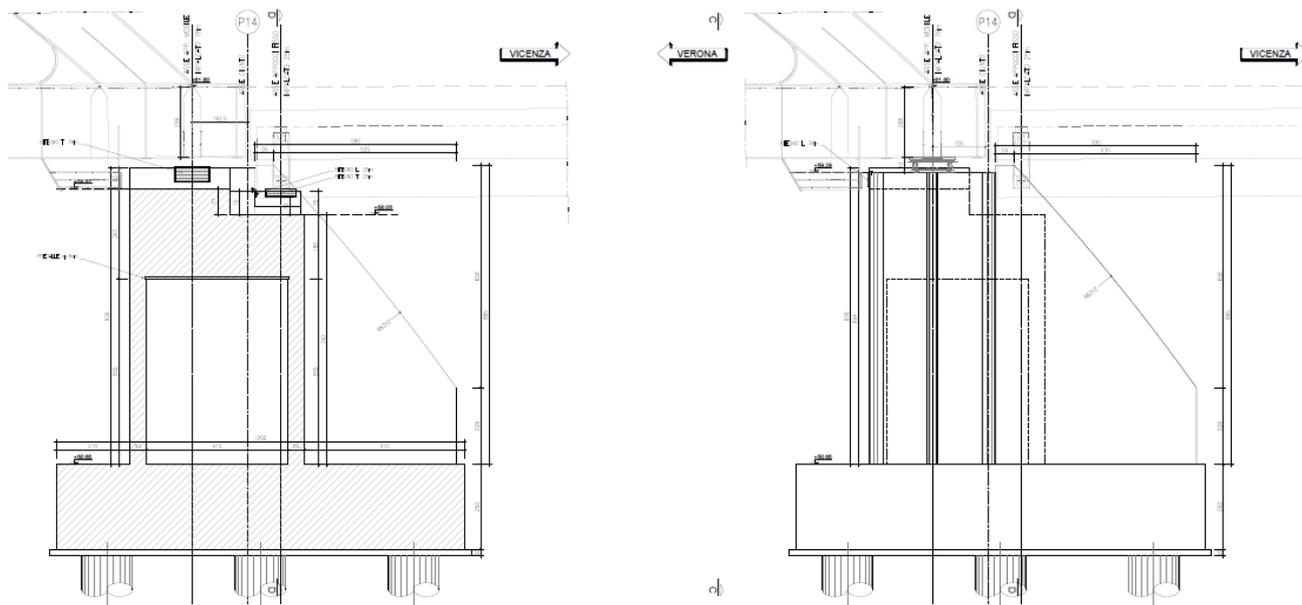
Sezione (a sinistra) e prospetto (a destra) longitudinali rispetto all'asse del viadotto
